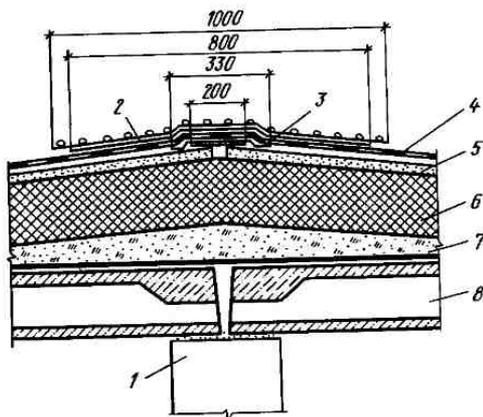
Конструкция конькового узла совмещенного покрытия:
